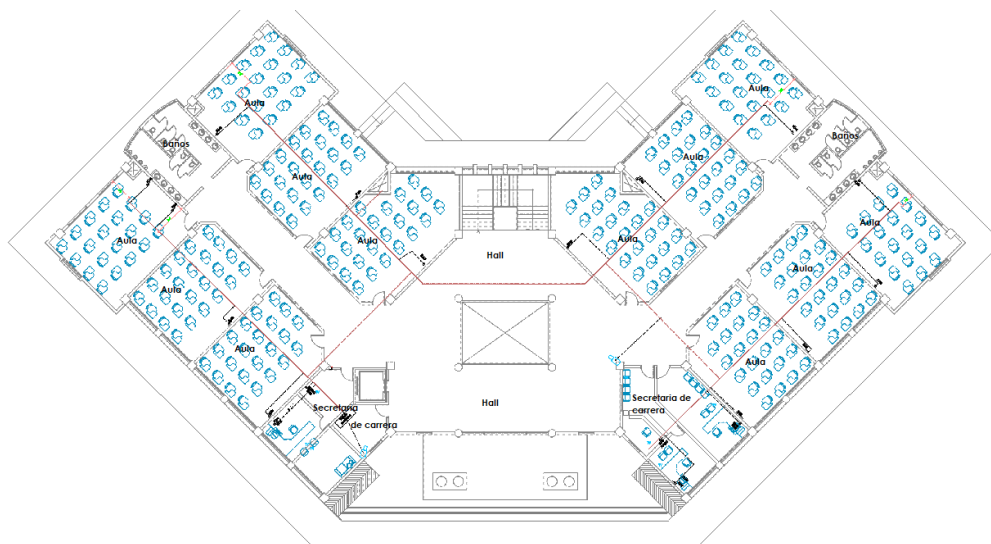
Planos de Infraestructura del Primer Piso de las Aulas 1,2,3 y 4.
